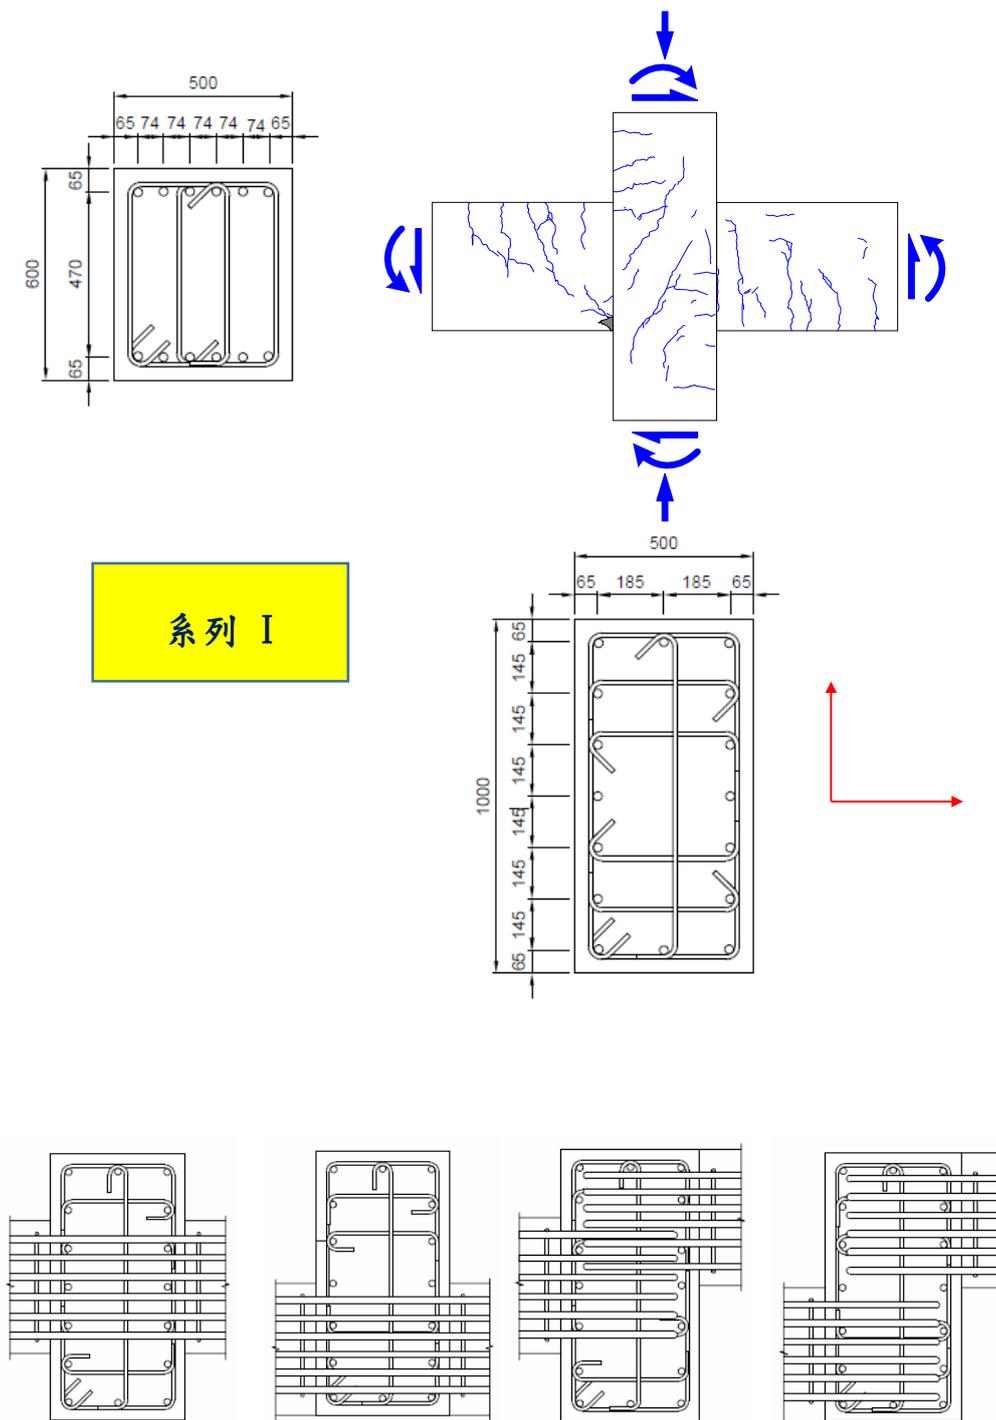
RC 梁柱接頭試體梁柱構材斷面及平面圖
